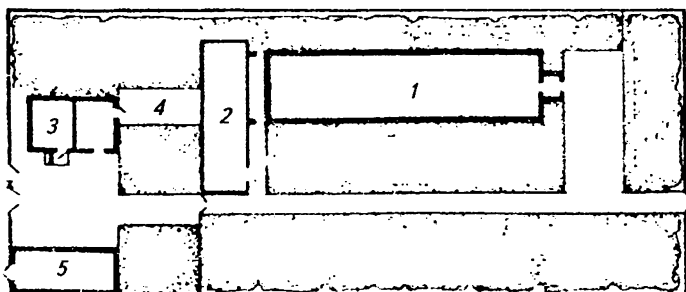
Генеральный план семейной фермы на 50 самок нутрий:
